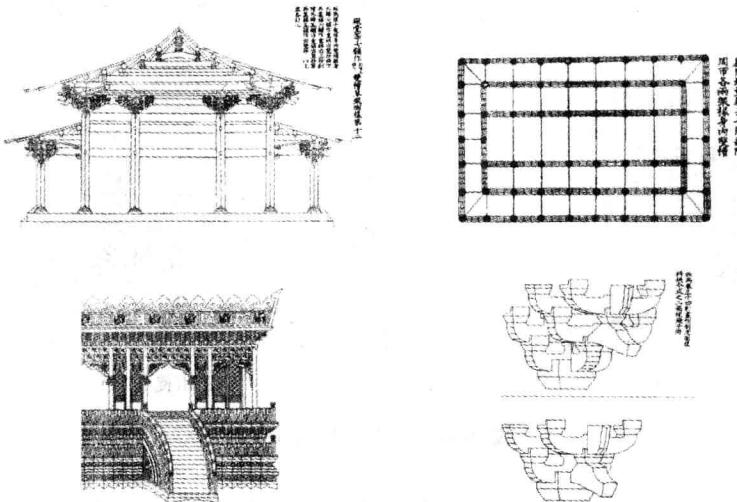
《营造法式》中的立面图、平面图、立体图和构件组装图
